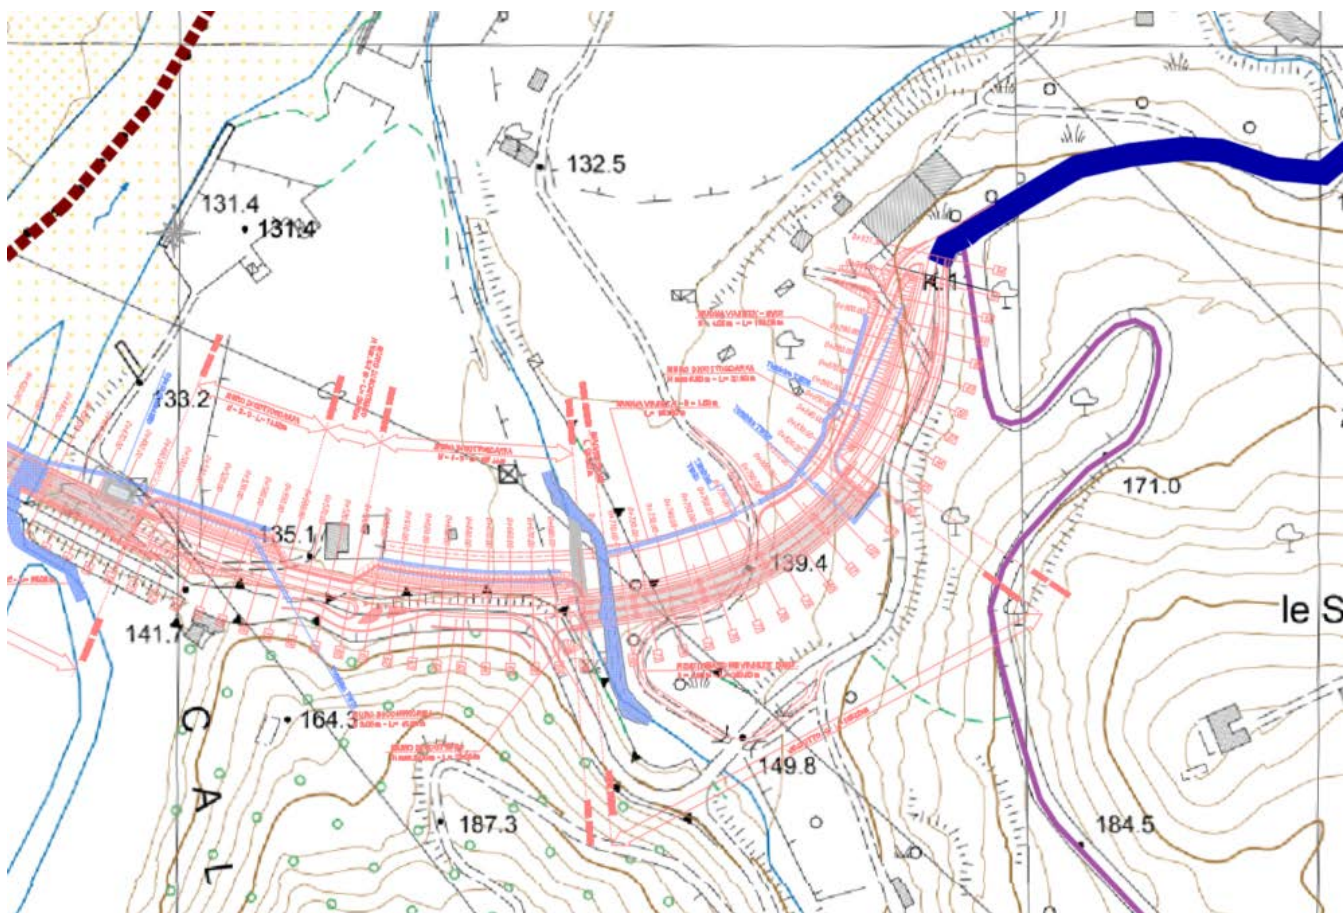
Inizio progetto a spalla riva dx ponte Trionto
